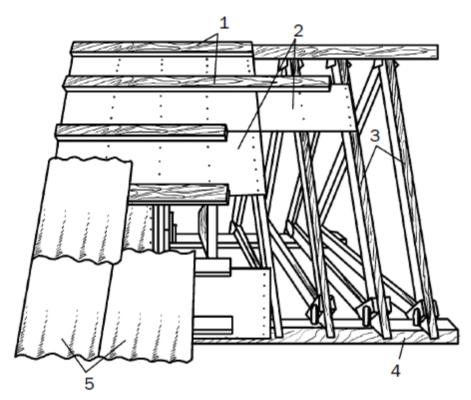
Конструкция двухскатной крыши: 1 – обрешетка; 2 – настил; 3 – стропильные ноги; 4 – мауэрлат; 5 – шифер
